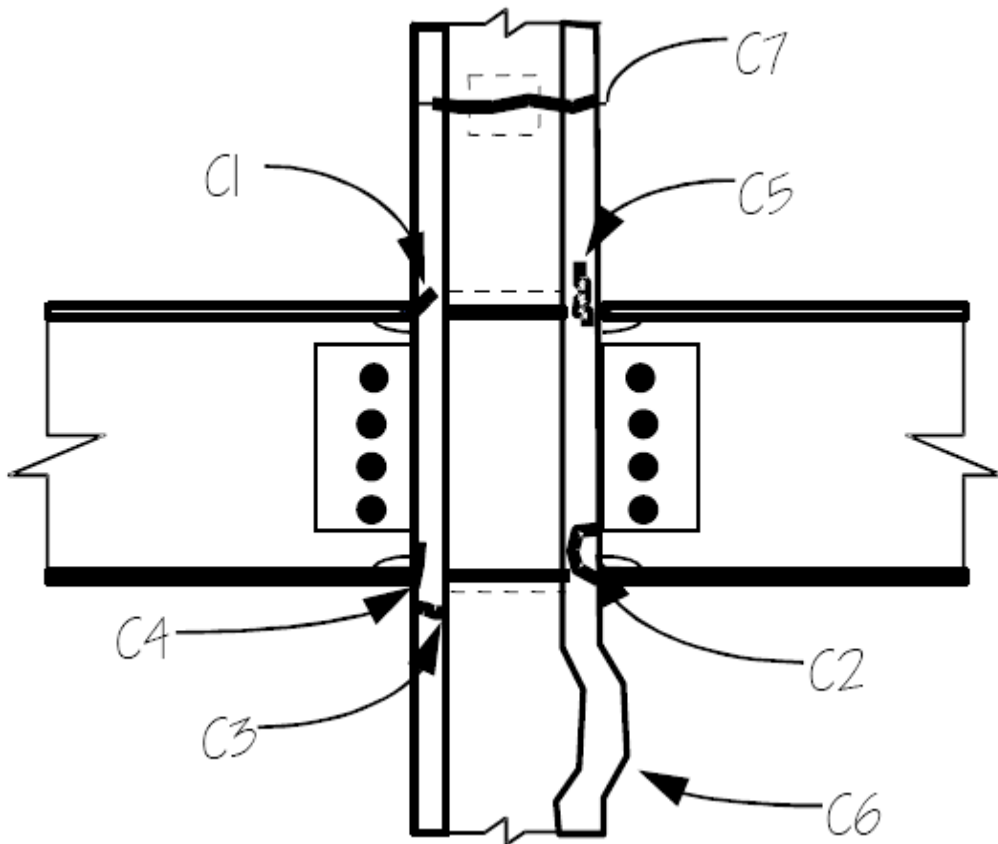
22 Daños típicos en columnas (SAC Joint Venture, 2000).
